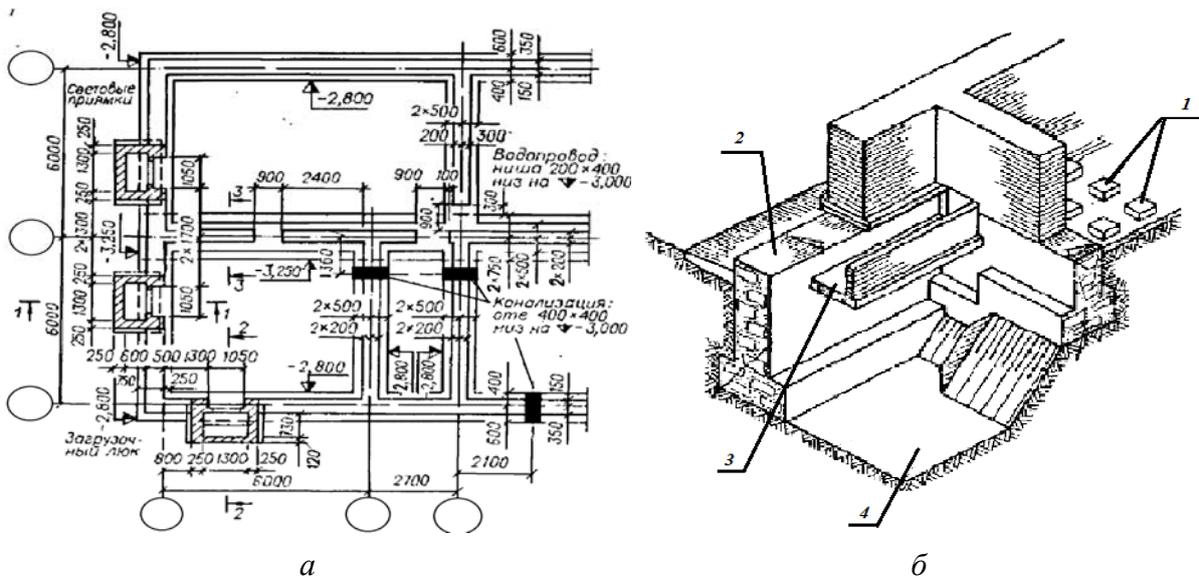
Монолитные ленточные фундаменты: а — план фундамента; б — общий вид фундамента: 1 — кирпичные столбики; 2 — гидроизоляция 2-го слоя толя; 3 — непроходной подпольный канал; 4 — грунт вынут условно, при переходе к повышенным отметкам заложения внутренних фундаментов высота уступов до 0,5 м
